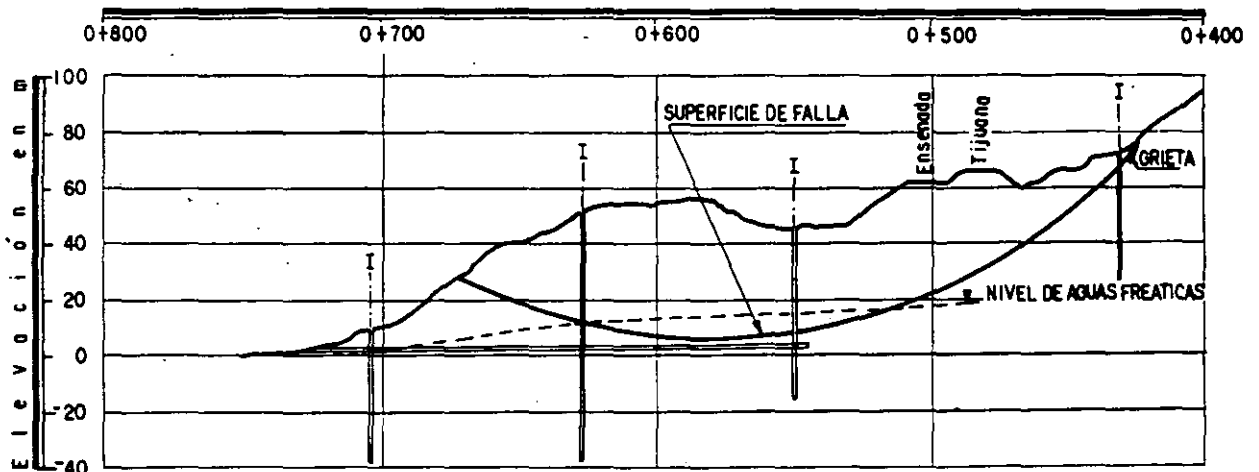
Perfil de la falla del km 15 + 500 de la autopista Tijuana-Ensenada, mostrando la galería filtrante (Ref. 30).
